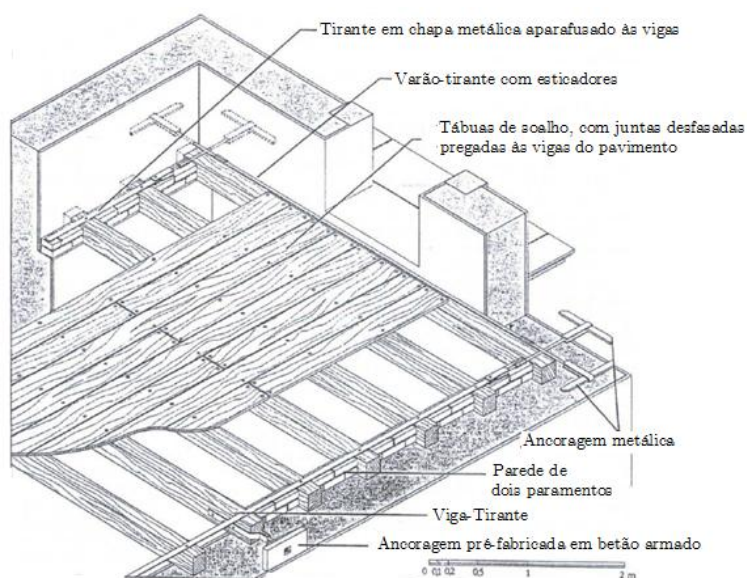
Exemplo da aplicação de tirantes para melhoria das ligações entre paredes e pavimentos de madeira. [5]
